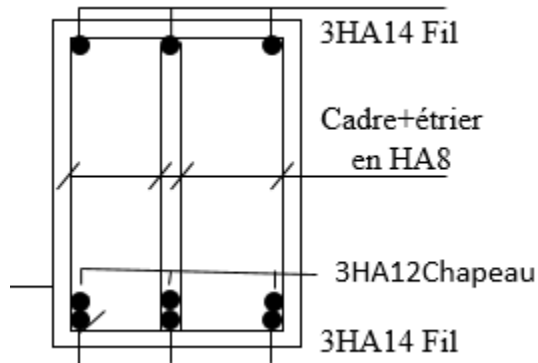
Ferraillage en travée d'une poutre secondaire.
